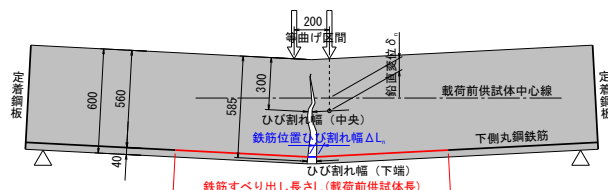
鉄筋すべり出し長さひび割れ幅測定位置
